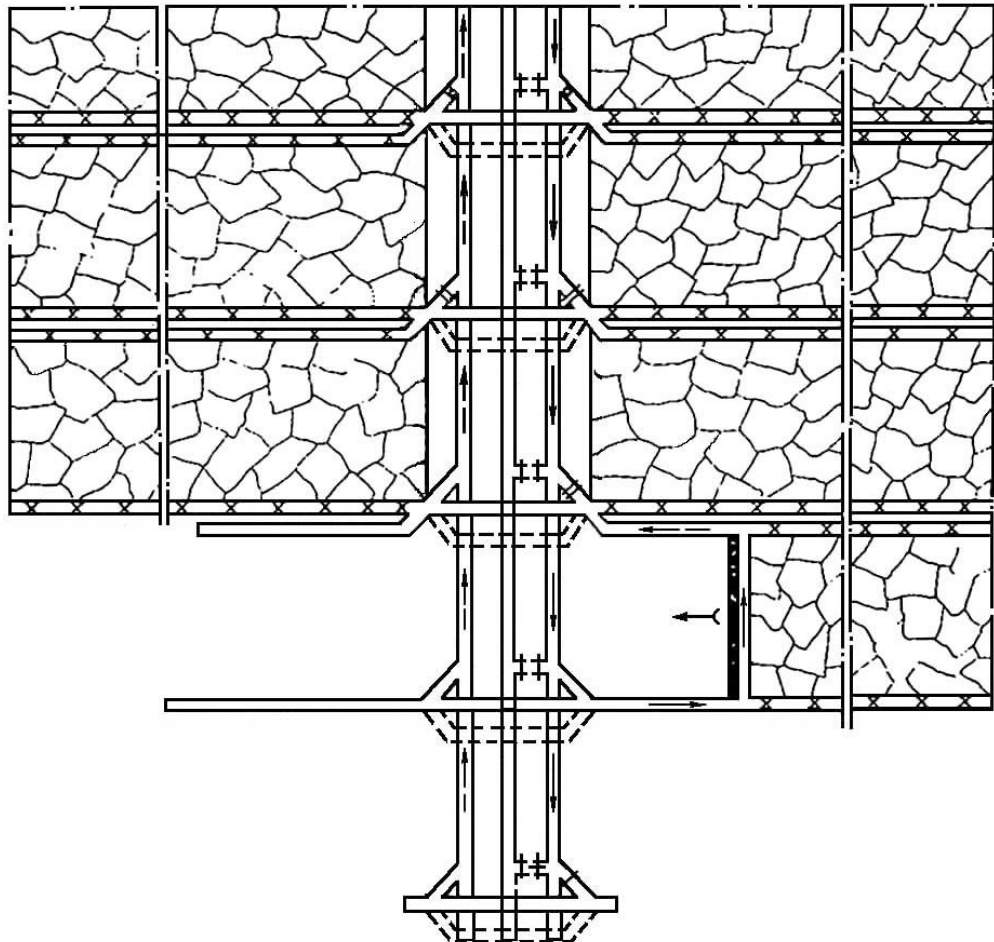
Охорона виробок газобетонним кріпленням
